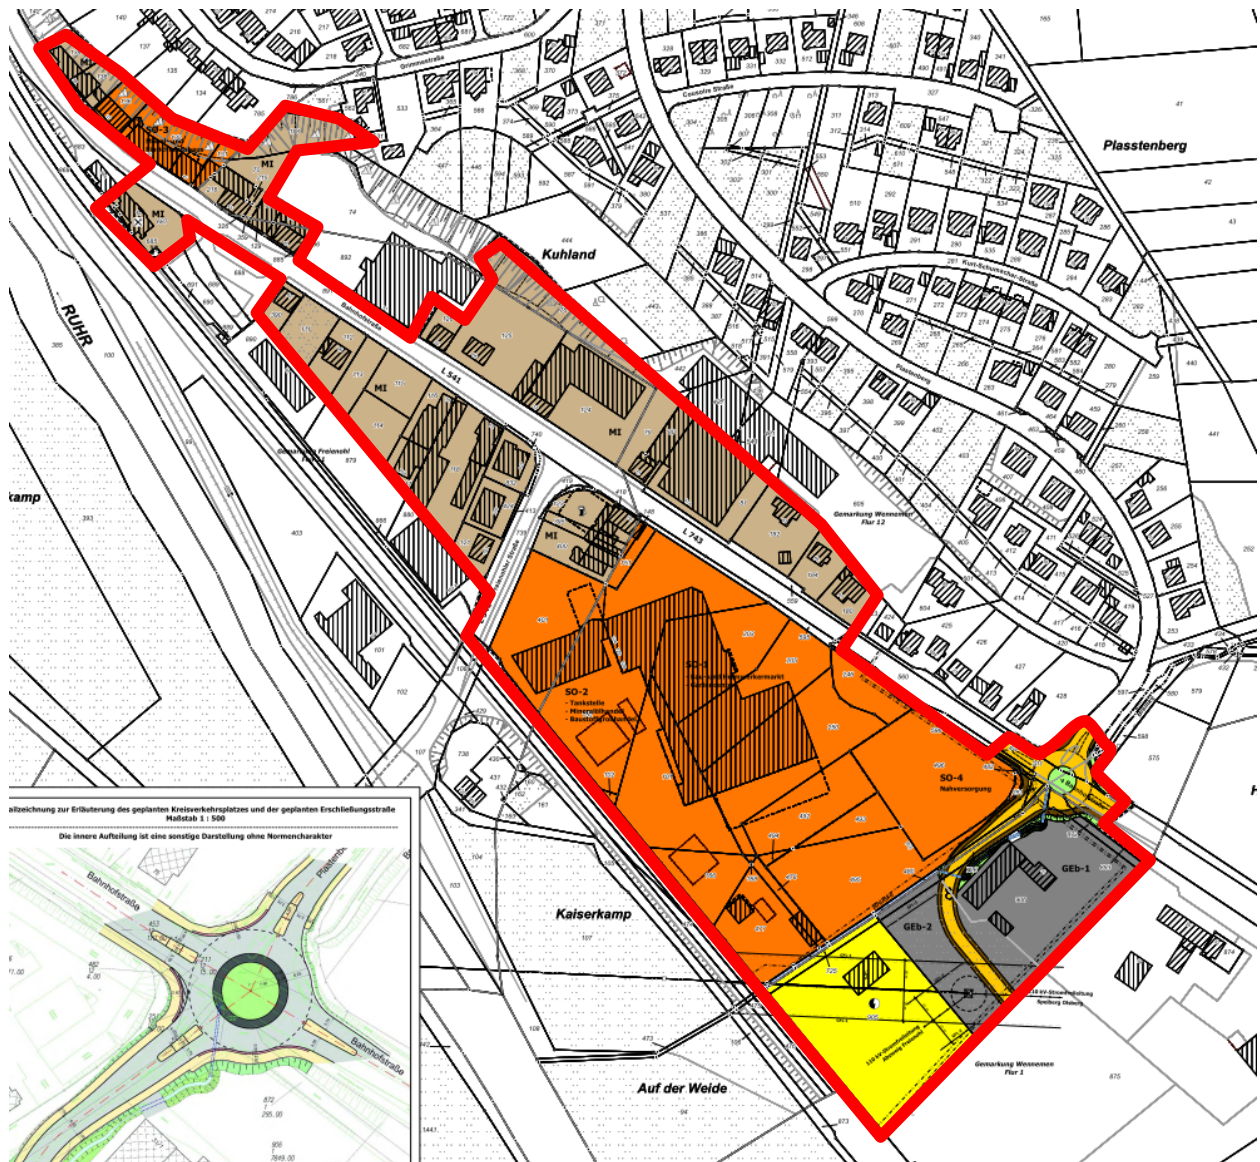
Rechtskräftige Festsetzungen des Bebauungsplans mit Änderungsbereich (gesamter Geltungsbereich, rot umrandet)
